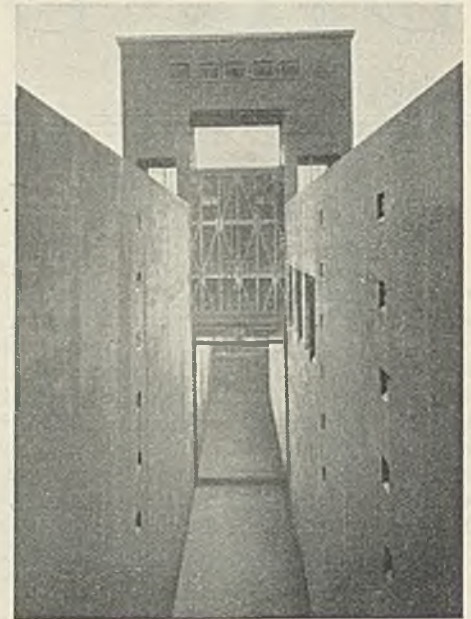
Unterkammer und Unterhaupt. Rechts Überlauföffnungen, im Hintergrunde Dammbalkenverschluß.
